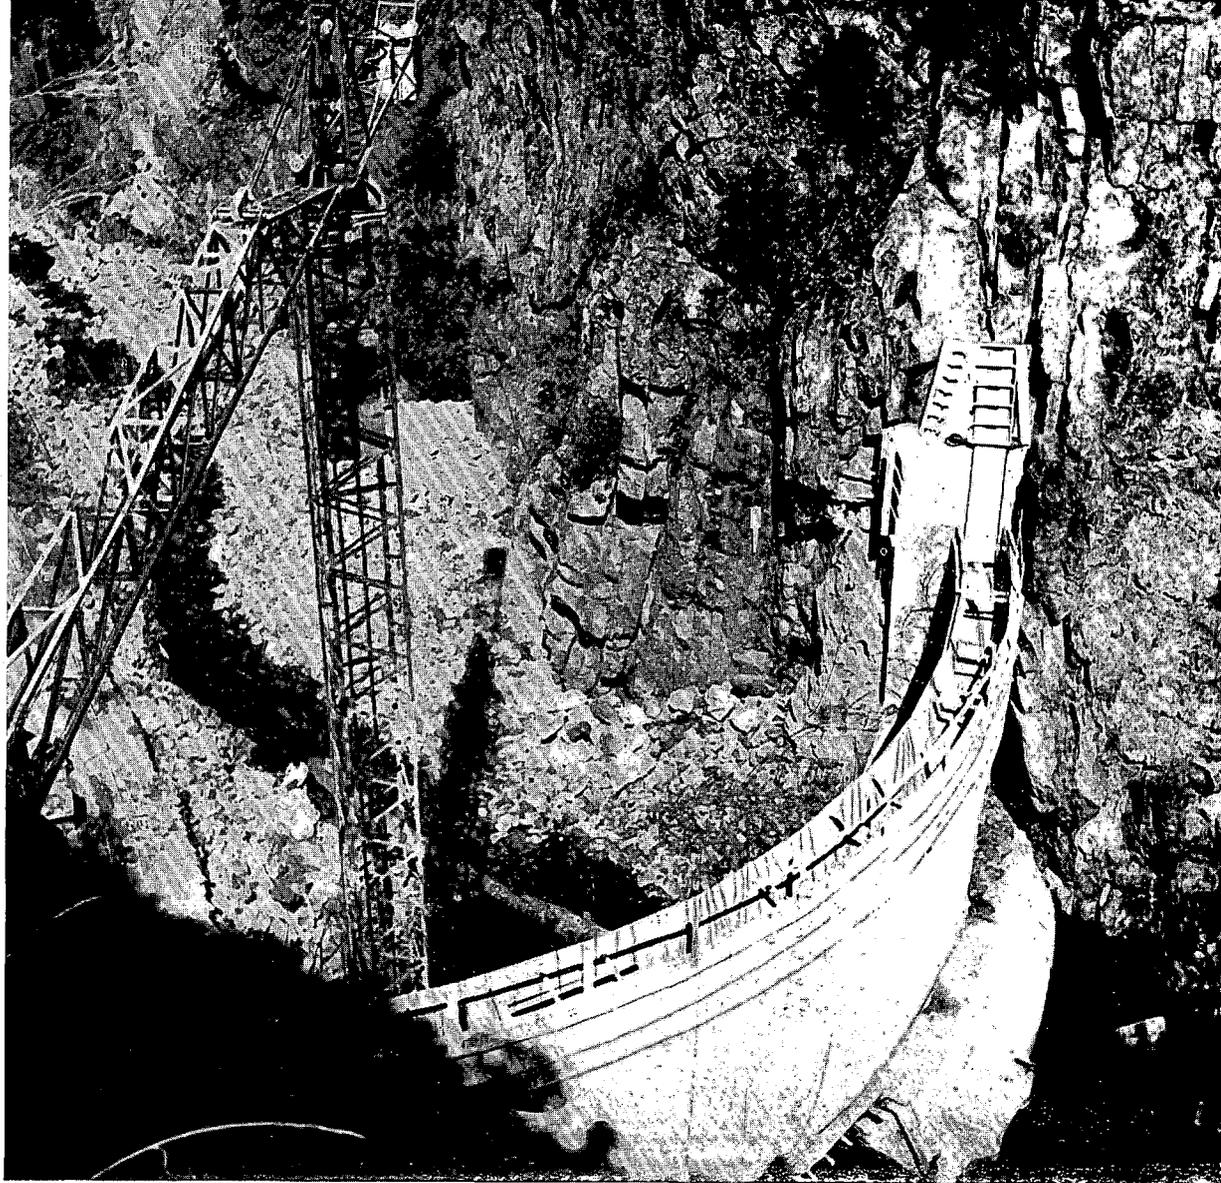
Ataguía de Santa Eulalia en construcción.
